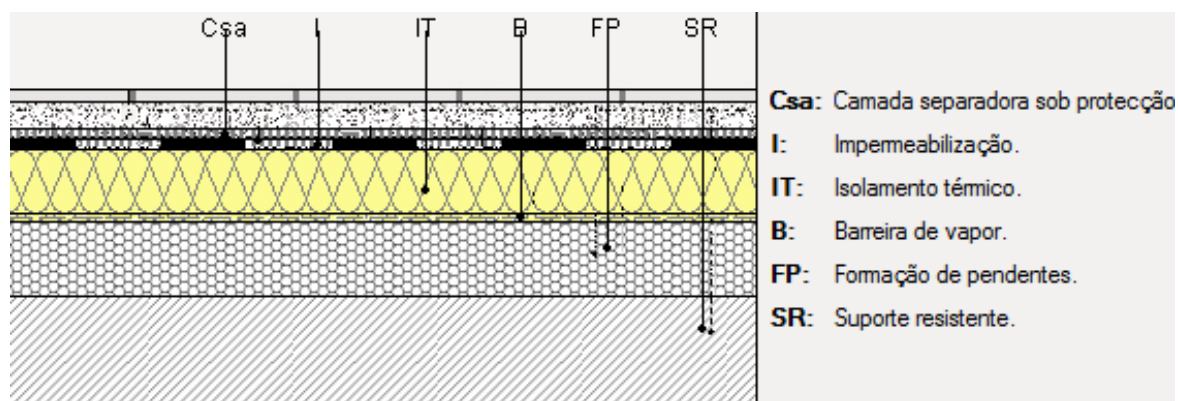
Cobertura plana acessível, não ventilada convencional, com pavimento fixo, impermeabilização através de lâminas asfálticas [37]
